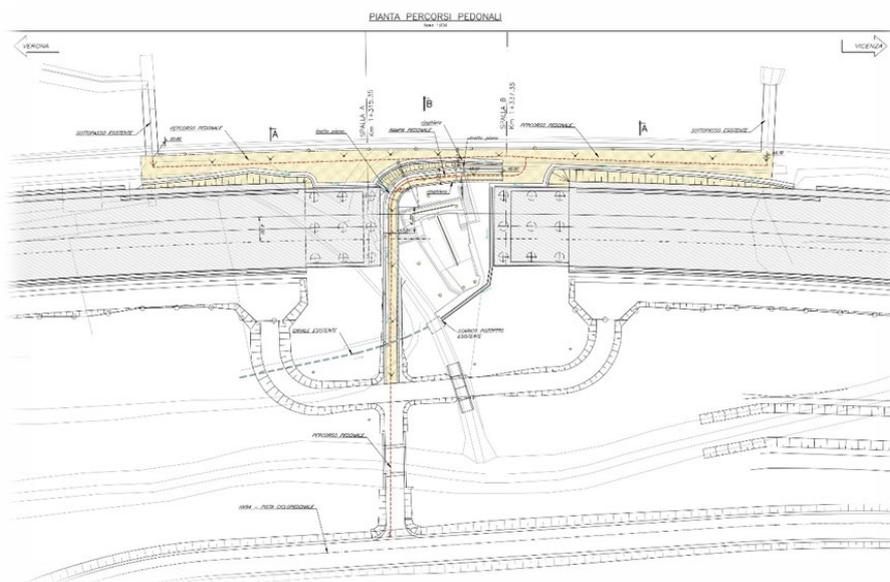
Pianta dell'impalcato e delle fondazioni (stralcio Tav. IN1711E12PZV11900002A: Percorso accessibilità fontana)
